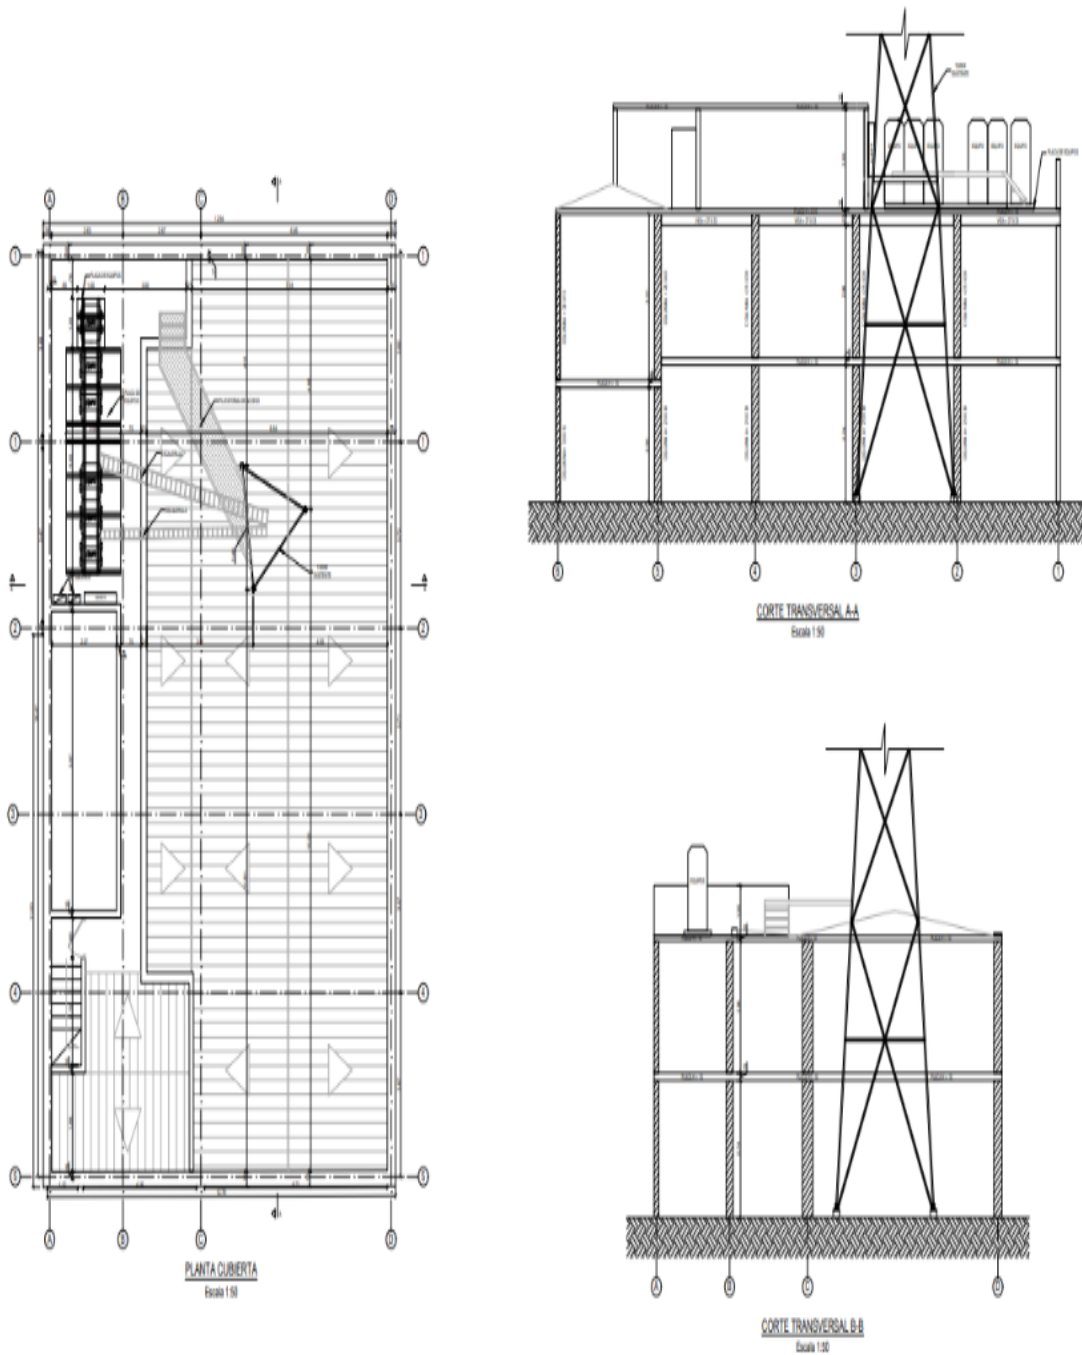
Planta cubierta, corte transversal A-A, corte transversal B-B
